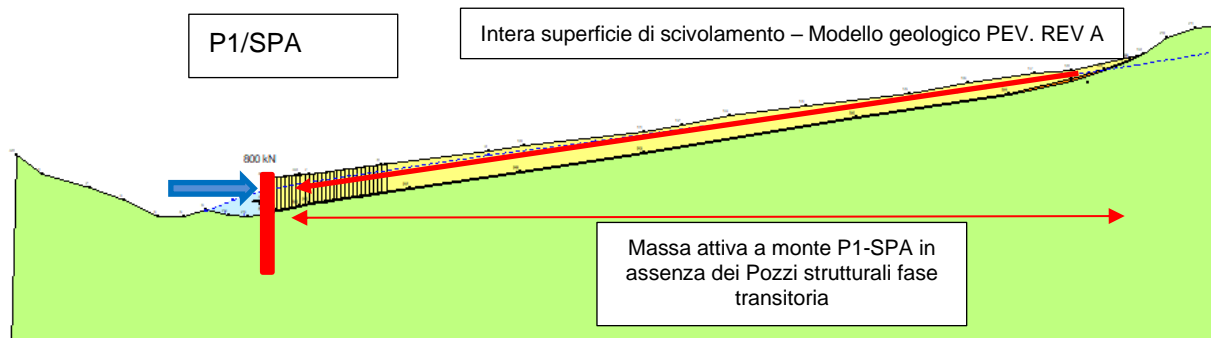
Schema concettuale determinazione delle spinte di frana sulla Pila/Spalla 1 in condizioni statiche – Breve Termine
